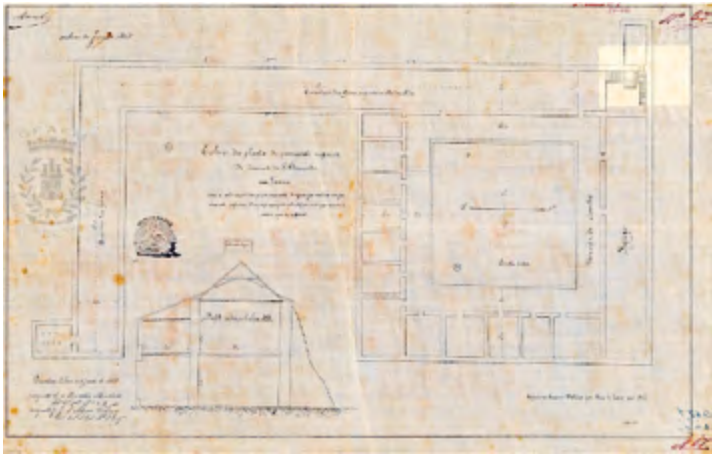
Esboço da planta do pavimento superior do Convento de S. Bernardo em Tavira, 1865. PT-GEAEM/DIE-8631-5-68-83.
